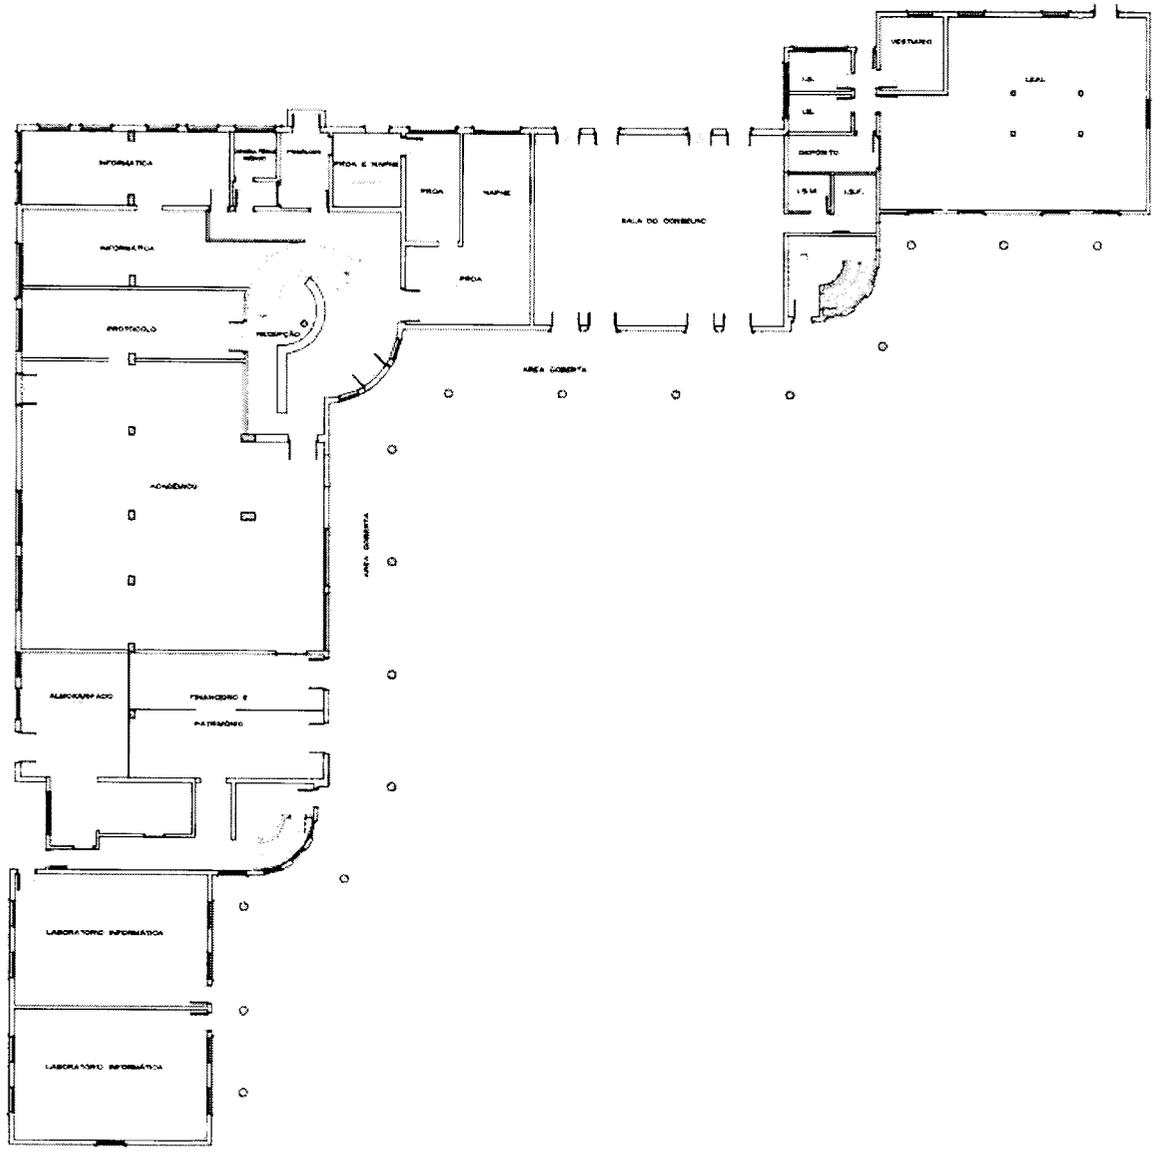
PLANTA DE IMPLANTAÇÃO ATUAL DO SETOR LITORAL
